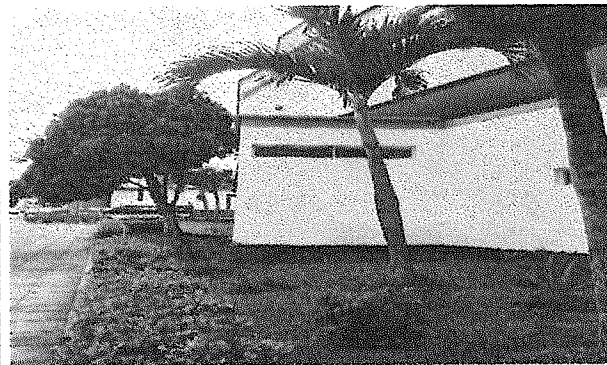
ESTACION NORTE (Intervención fachada principal)
